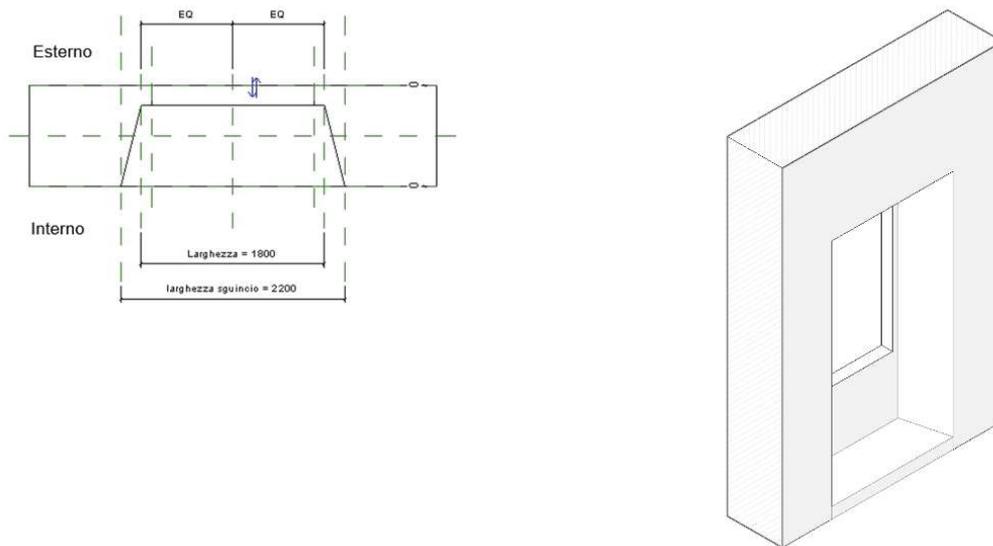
Rappresentazione planimetrica e assonometrica della famiglia infisso.
